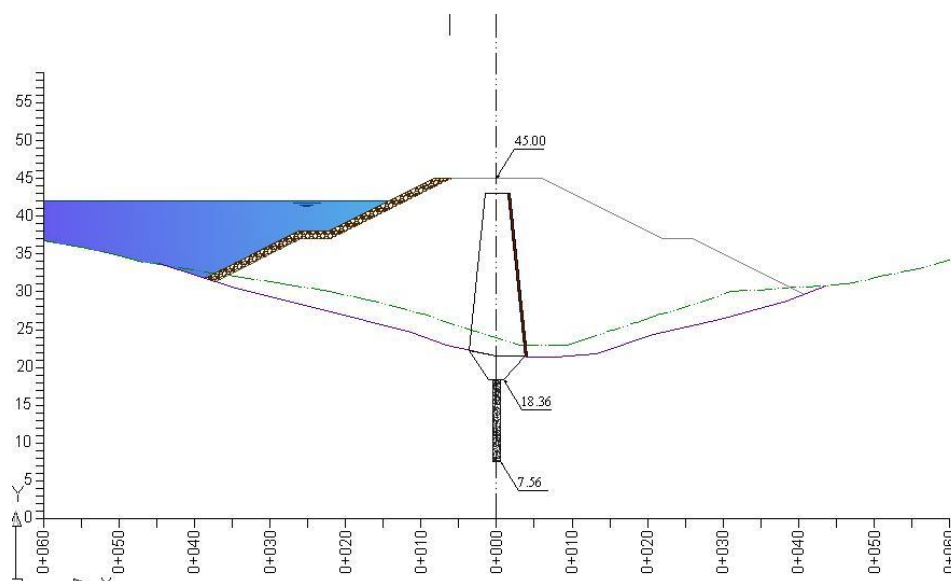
Detalles de Cotas en Terreno Natural y Cotas de Excavaciones en Sección Típica
